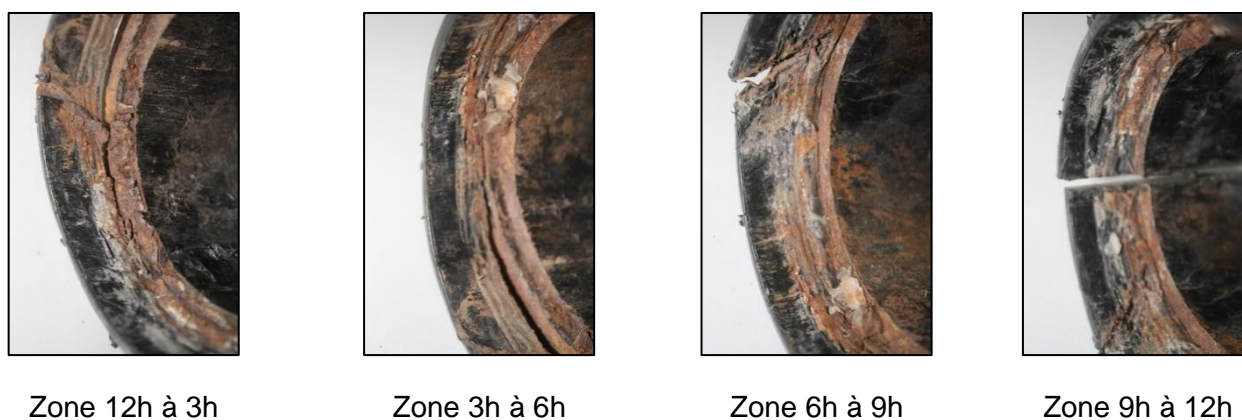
Photos montrant l'intérieur du manchon et son recouvrement avec le conduit amont
